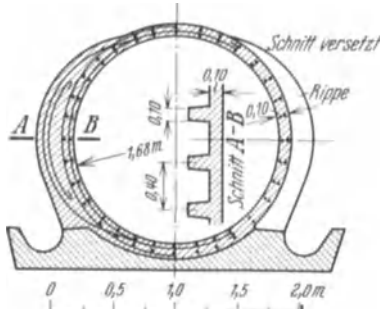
Italienisches Eisenbetonrohr zusammenhängender Bauweise mit Rippen. (Beton u. Eisen 1927.)
